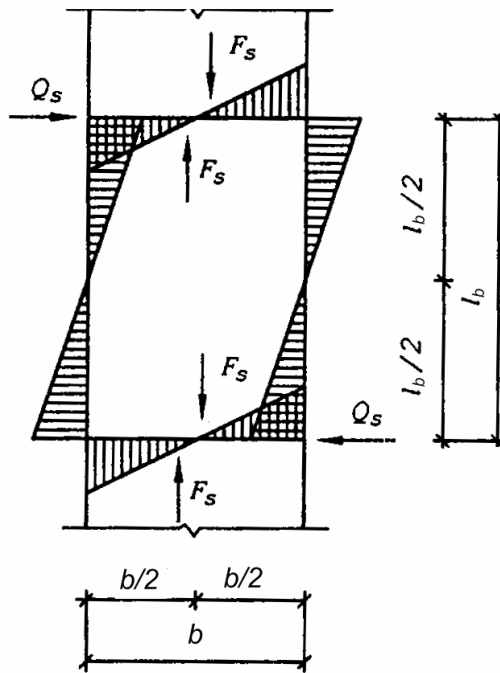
Розрахункова схеми наскрізної колони на планках
